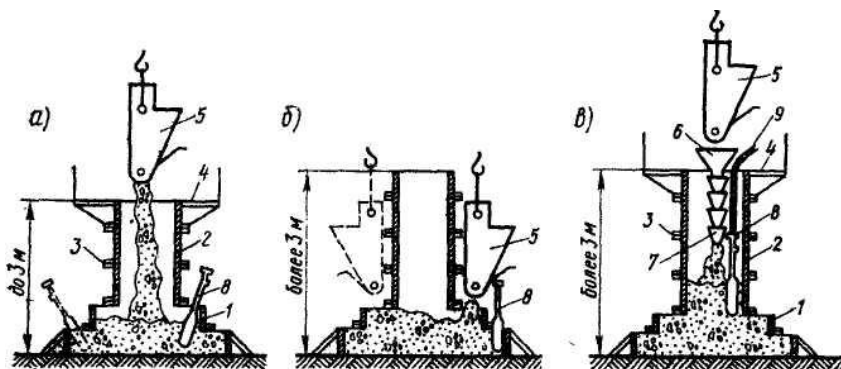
Бетонирование ступенчатых фундаментов:
